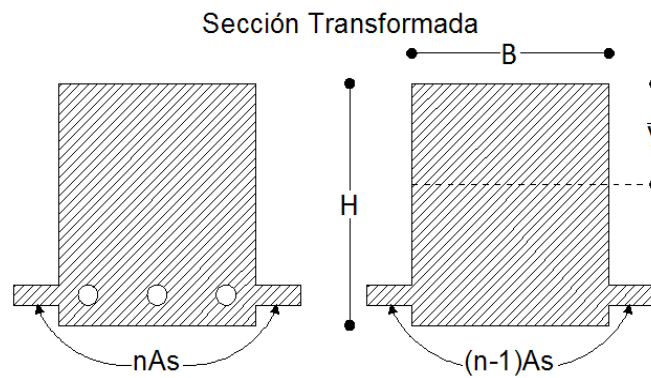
Estado I – Esfuerzos elásticos y sección no fisurada
